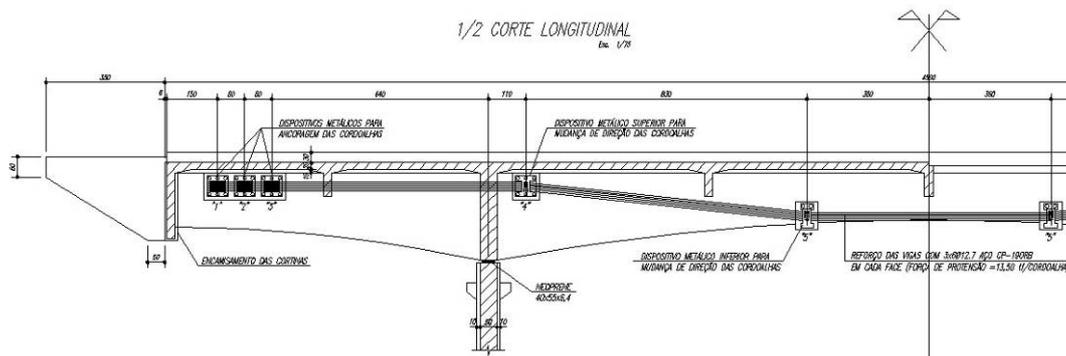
Reforço das vigas de uma ponte com feixe de monocordoalhas fixadas por dispositivos metálicos. (Fonte: VITÓRIO, 2013)
